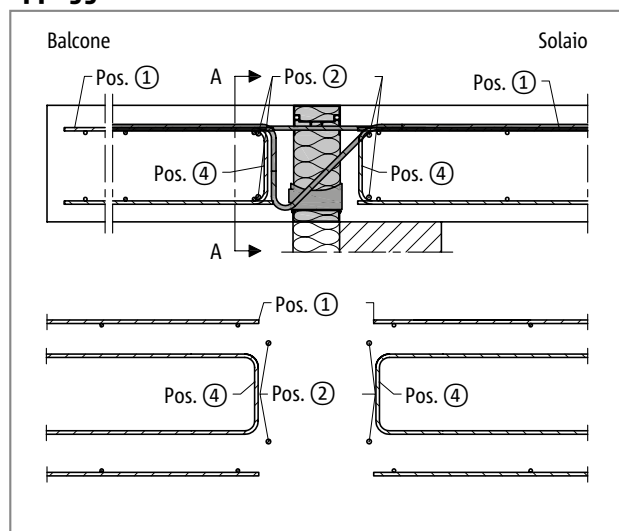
Schöck Isokorb® tipo K, armatura in opera con appoggio diretto
